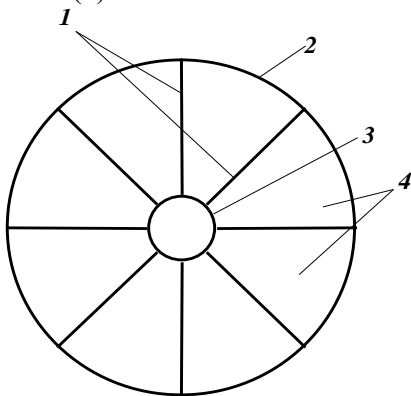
Конструкція висячого покриття на круглому плані та армування плити покриття оболонки
